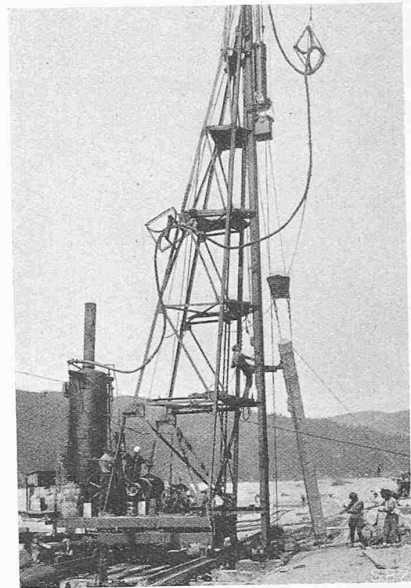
Rammgerüst der Eisenbetonpfähle.
